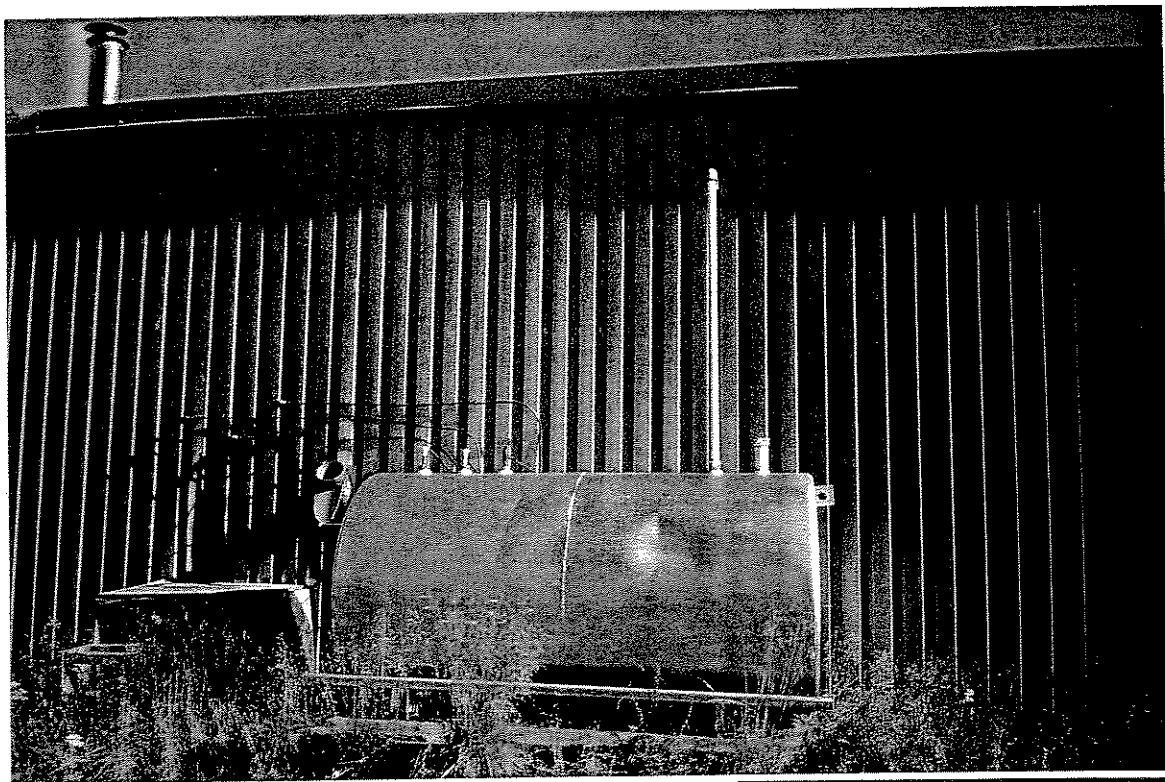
Réservoir de mazout 2 273 litres (T-161).
